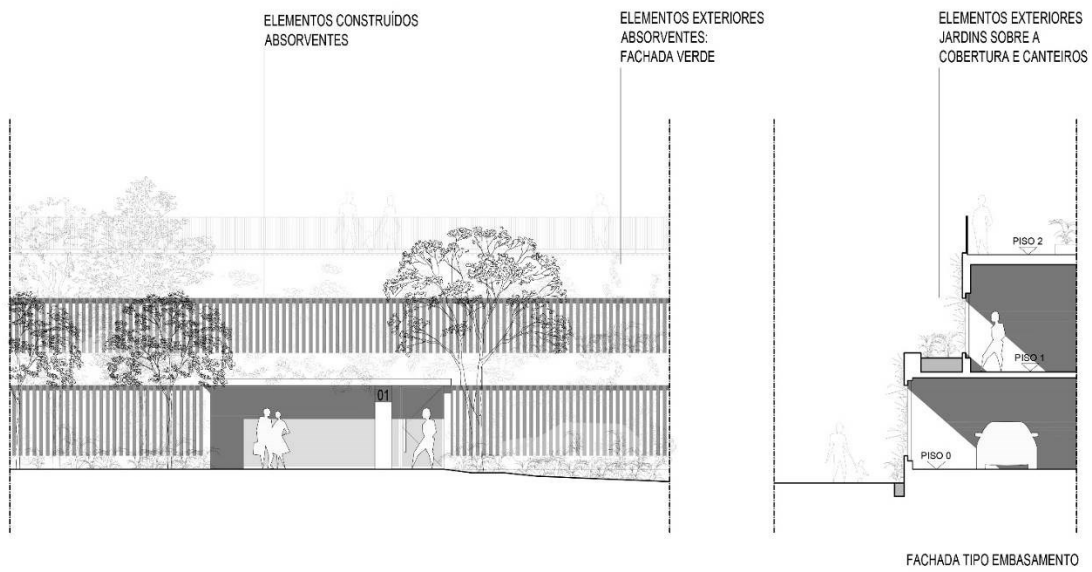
Esquema medidas de redução e controlo do ruído - Fachada Tipo embasamento.
